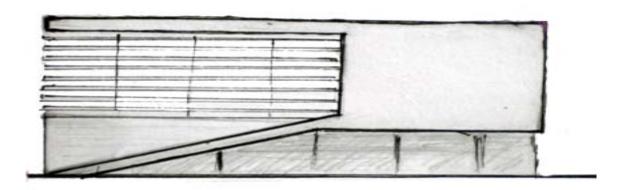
Primer boceto de propuesta para fachada principal (este).
